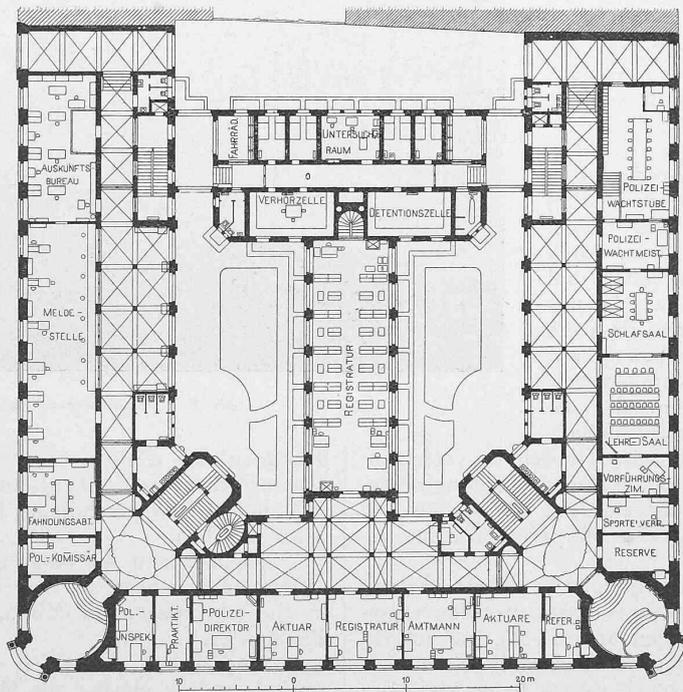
Grundriss vom Erdgeschoss. — Masstab 1 : 600.
